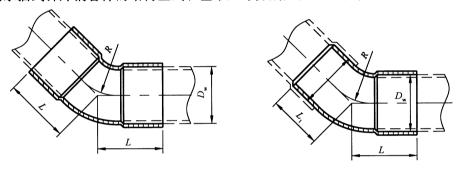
45°弯头 承插式钎焊铜管件
